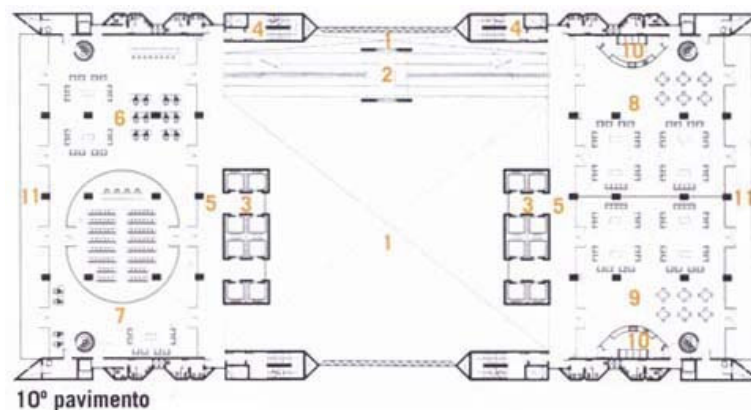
Planta do 10º pavimento (Fonte: Décio Tozzi Arquitetura)
